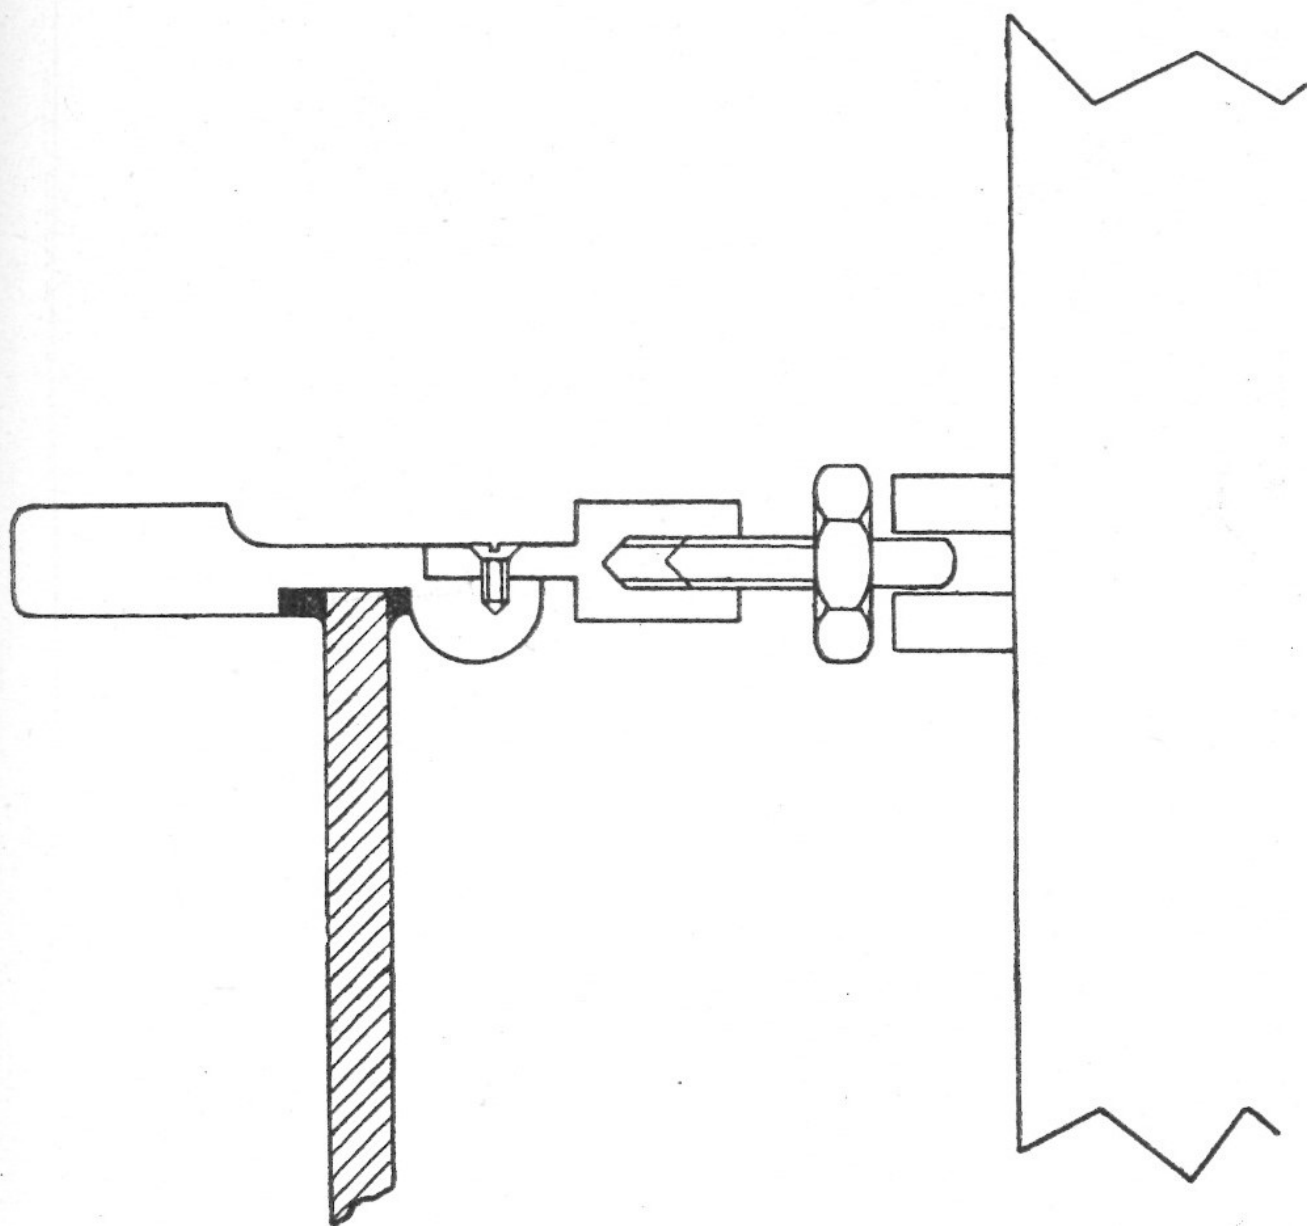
Attacco di un elemento di lente alla flangia portante
